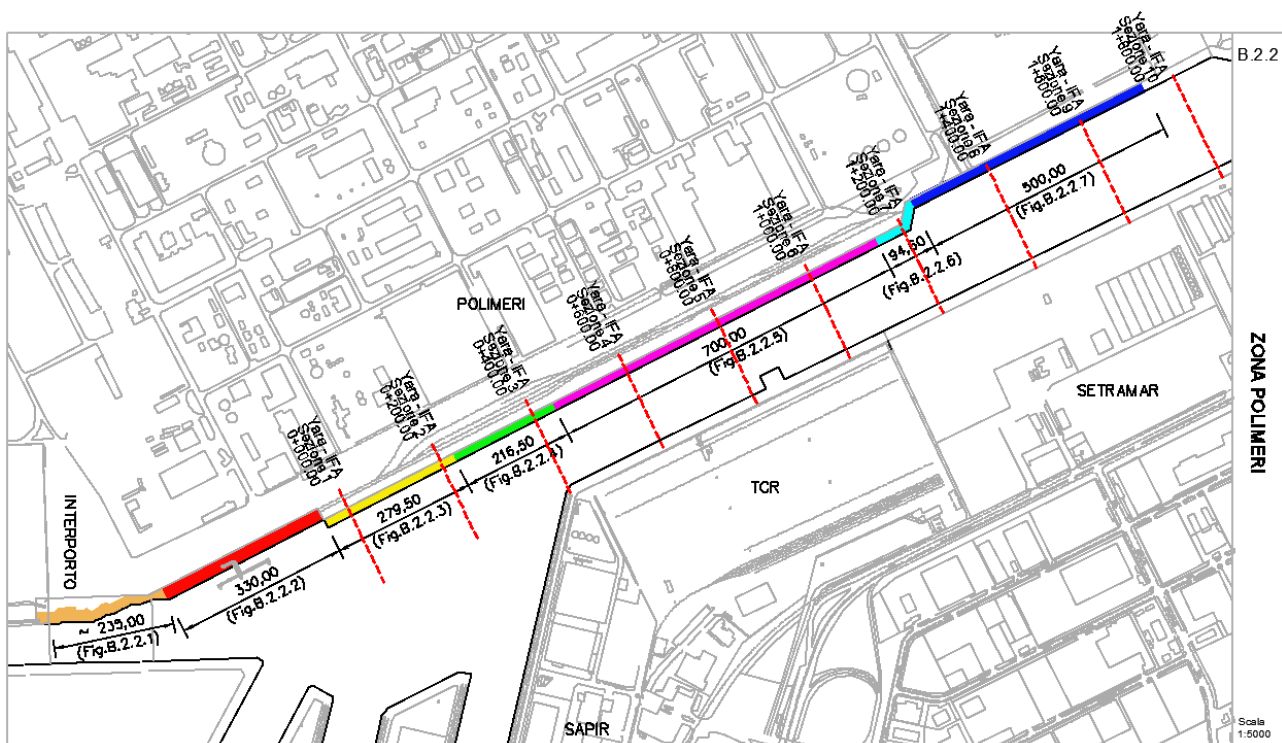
Stralcio planimetrico del Canale Candiano con l'indicazione delle sezioni e delle banchine in sinistra considerate nel tratto YARA - IFA
